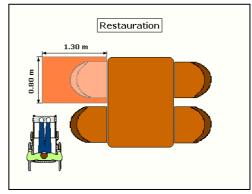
dimension d'une place adaptée pour handicapés moteurs
